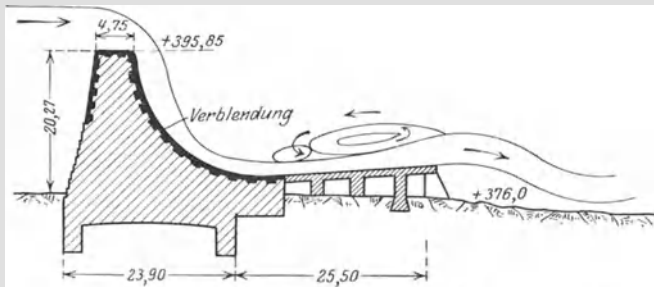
Querschnitt des Dracwehres. Maßstab 1:1000.
